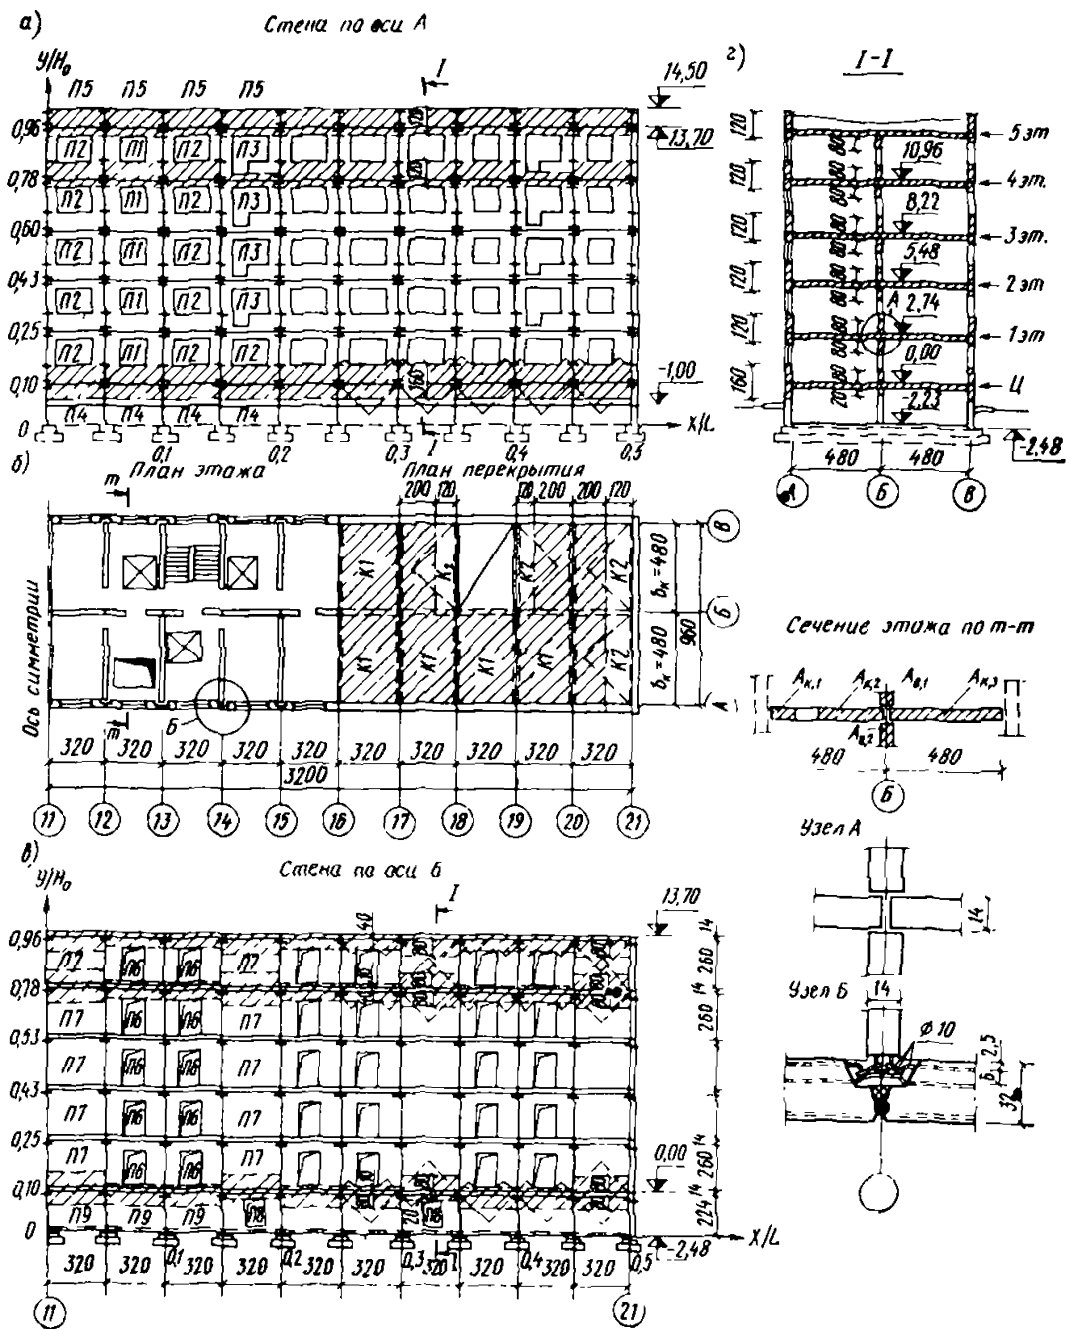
Расчетная схема крупнопанельного жилого дома I типа с поперечными несущими стенами
